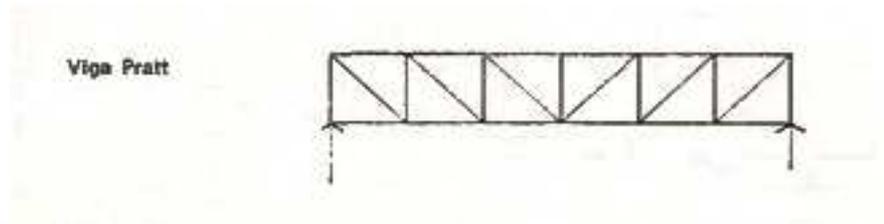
Modelo Viga Pratt. Fuente: Apuntes de Construcción II. Departamento de Construcción.
